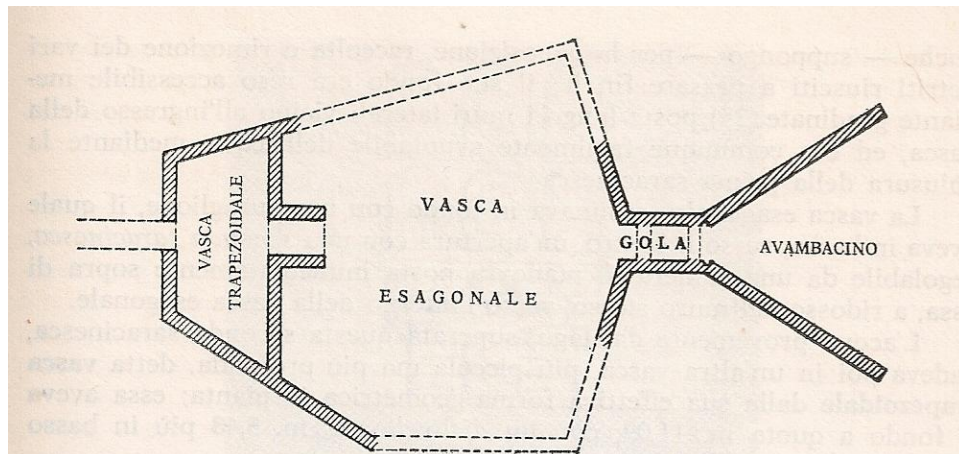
Incile romano, secondo il progetto di Claudio: pianta schematica.
